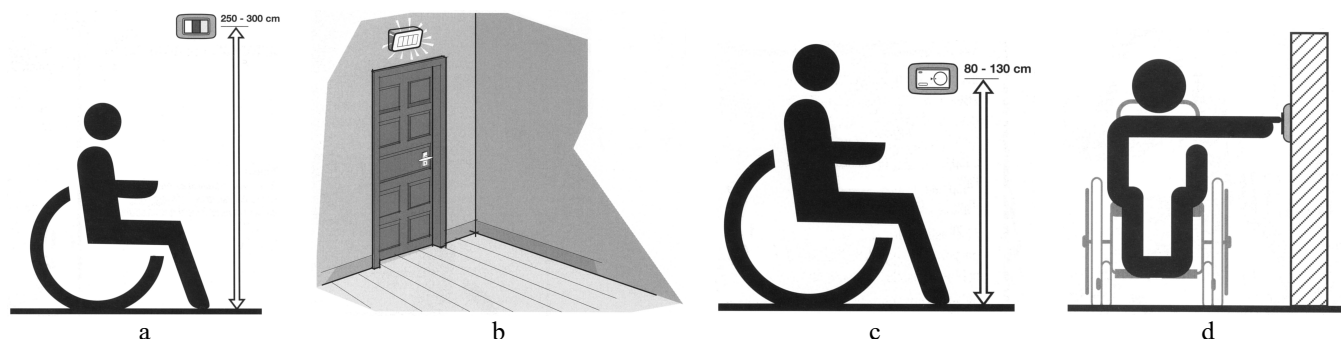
a) Altezza di installazione degli apparecchi di segnalazione - b) Cornice rialzata per scatola da incasso rettangolare - c) Altezza di installazione degli apparecchi di regolazione - d) Posizione di installazione degli apparecchi di regolazione.
